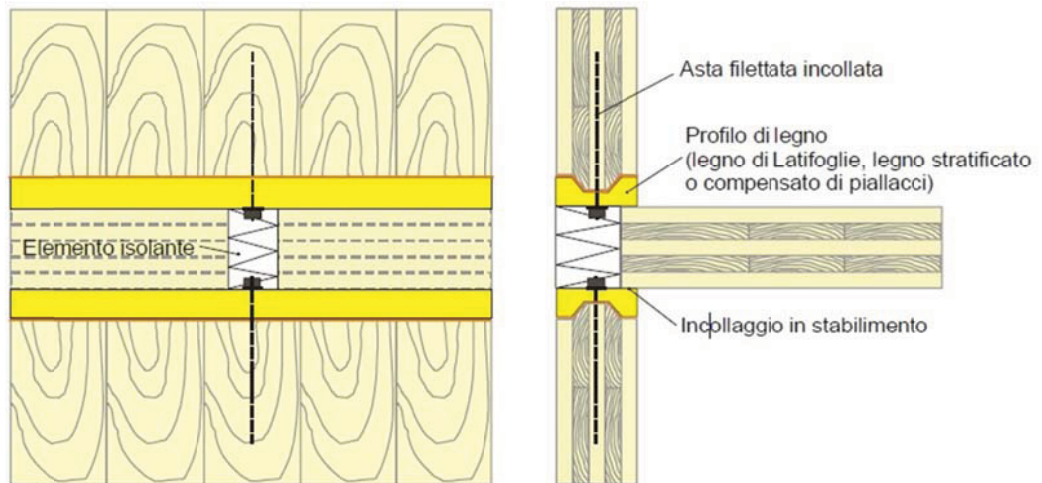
Giunzioni parete – solaio – parete con profili di legno.
